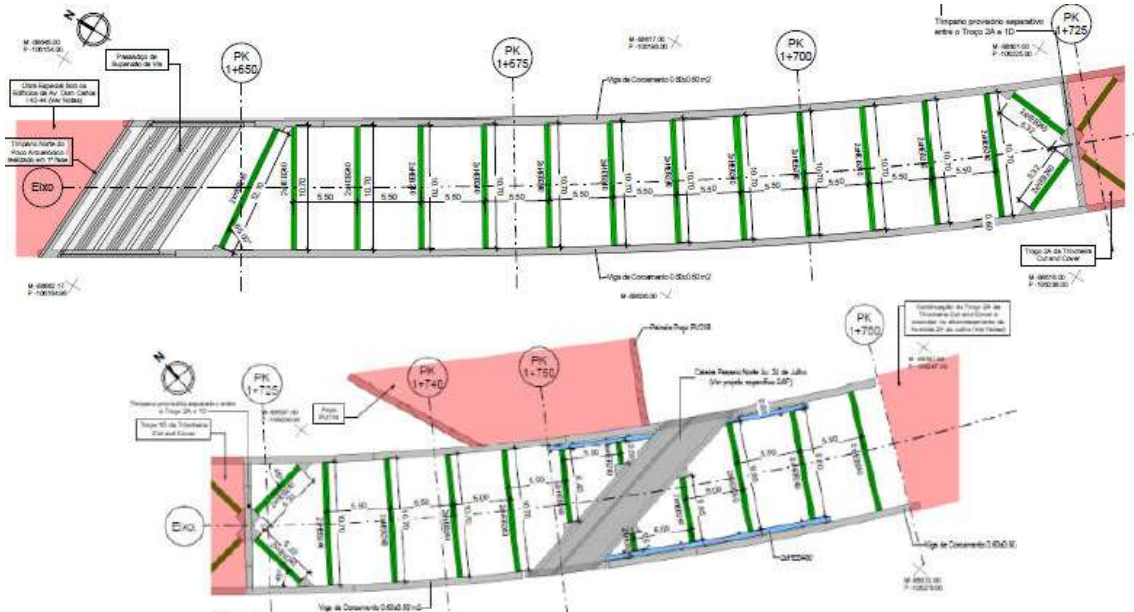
Contenção em Parede Moldada 600mm – Planta.
